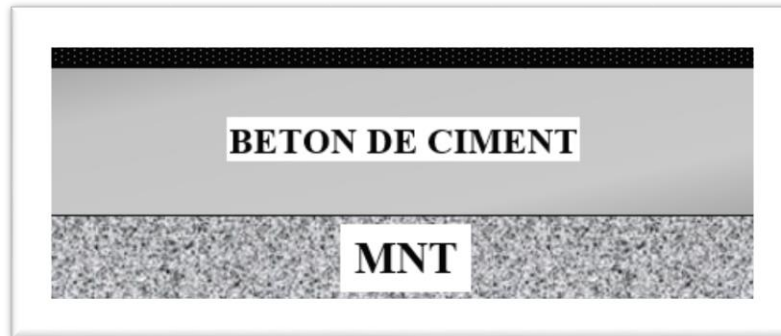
schématisation d'une structure en béton de ciment surmonte une couche de matériaux non traité.
